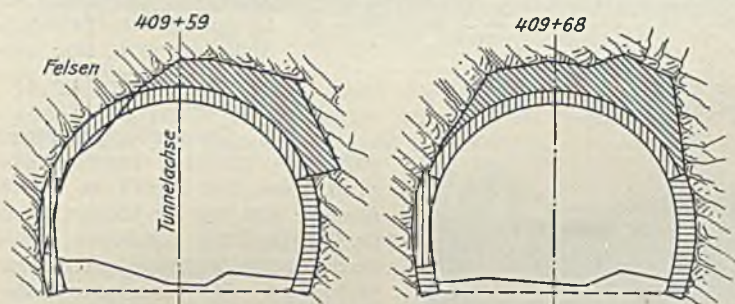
Hohlräume über dem Tunnelgewölbe.
